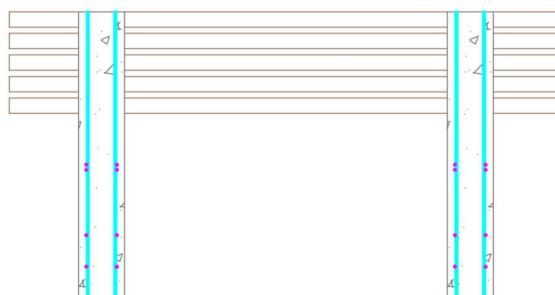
Vista frontal do banco que deverá ser produzido pela empresa prestadora de serviços.
